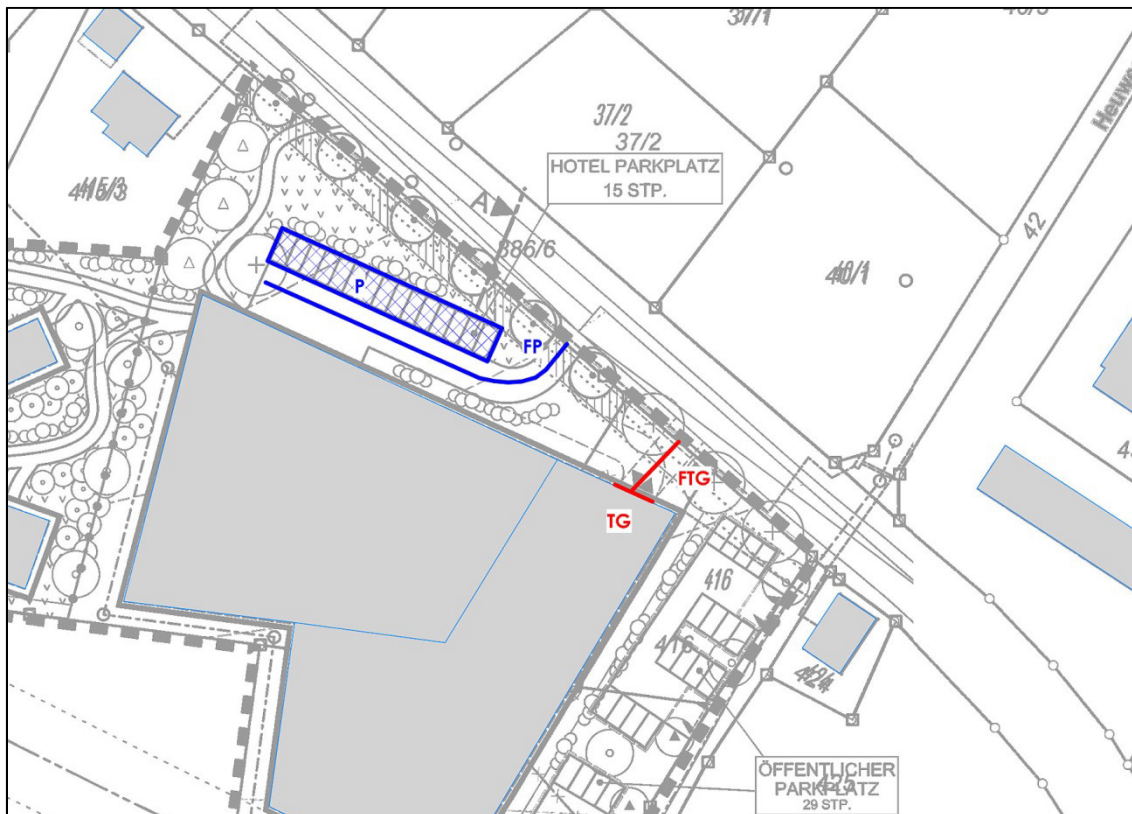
Lageplan mit Darstellung der relevanten Schallquellen im Geltungsbereich des Bauungsplans
